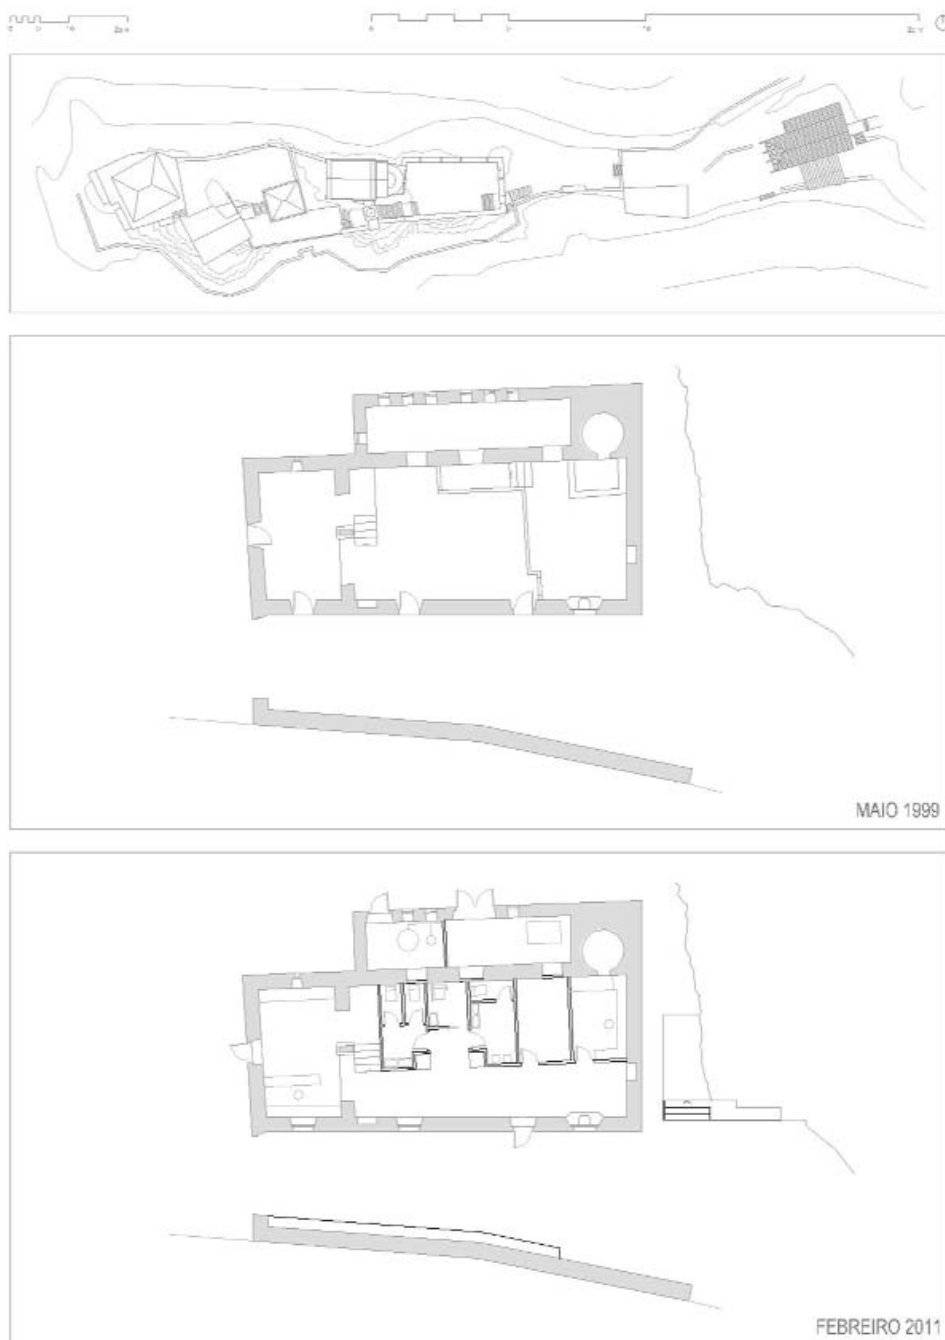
CAAVEIRO. Planta baixa da Casa dos Guardeses (Pavillón de servizos e aula).
